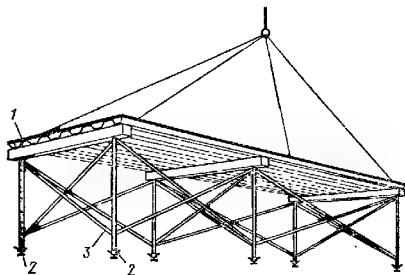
Крупнощитовая опалубка перекрытий:
